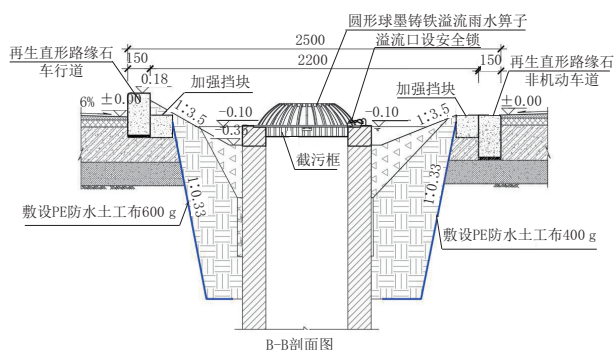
现状检查井改造为溢流雨水口剖面图(单位:mm)
